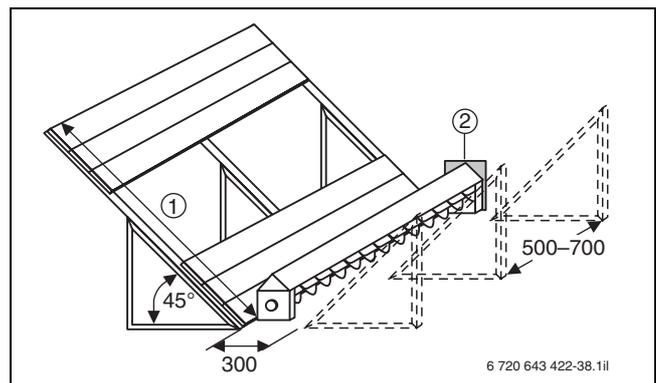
Schnecke direkt am Boden montieren (Maße in mm)
